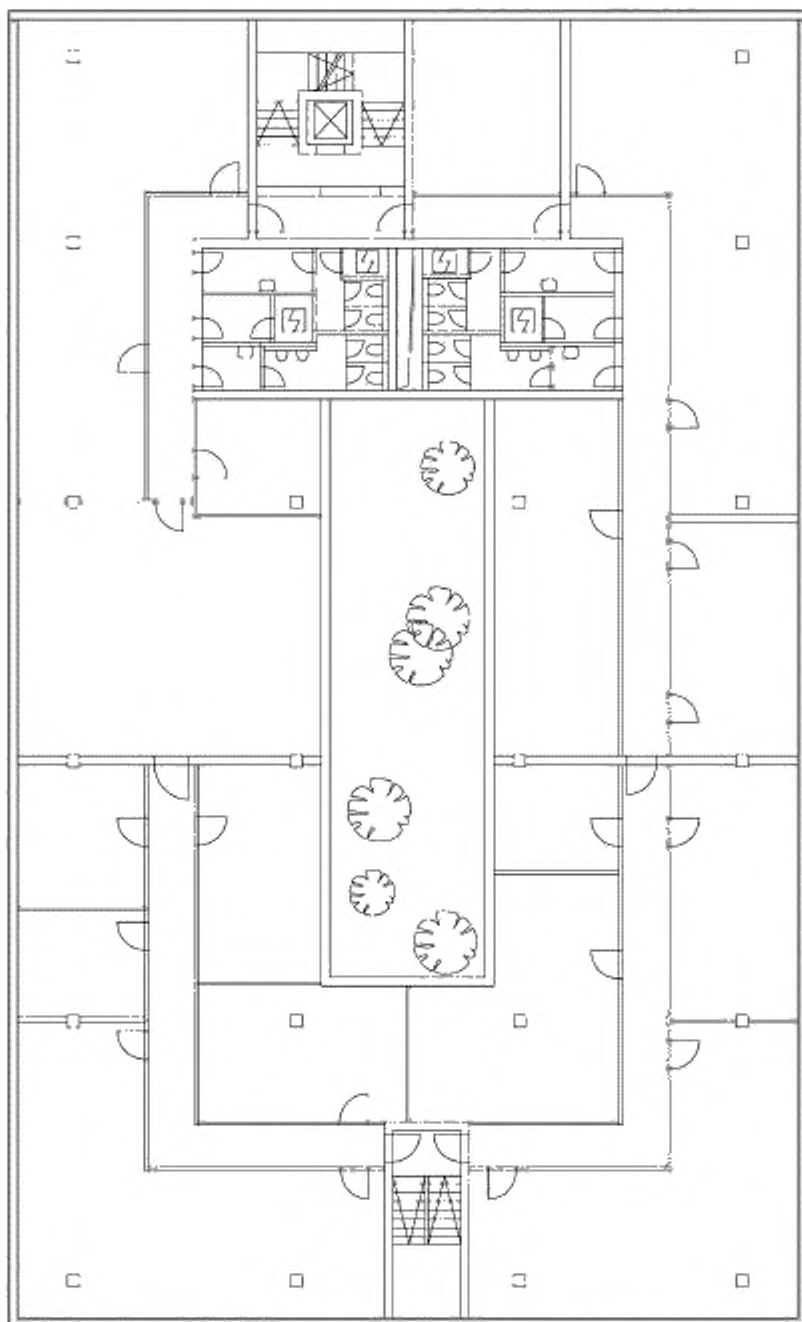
План этажа с указанием объектов, площадь которых входит во внешнюю площадь конструкции
